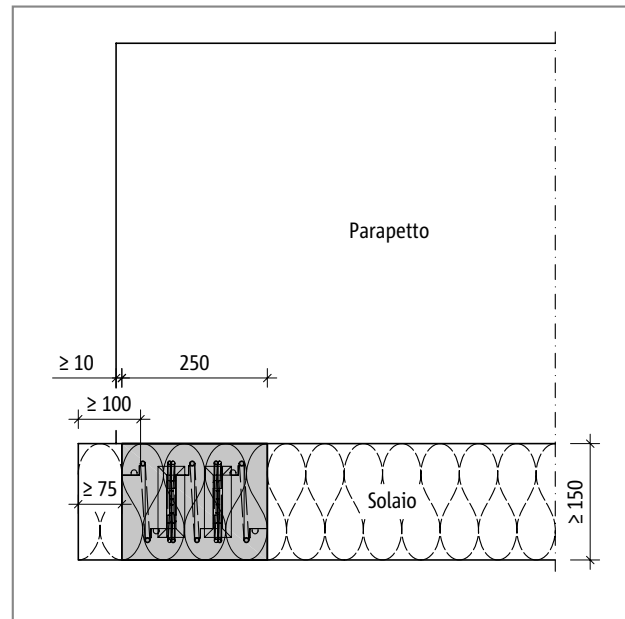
Schöck Isokorb® tipo ABXT - disposizione orizzontale, distanze tra i bordi
